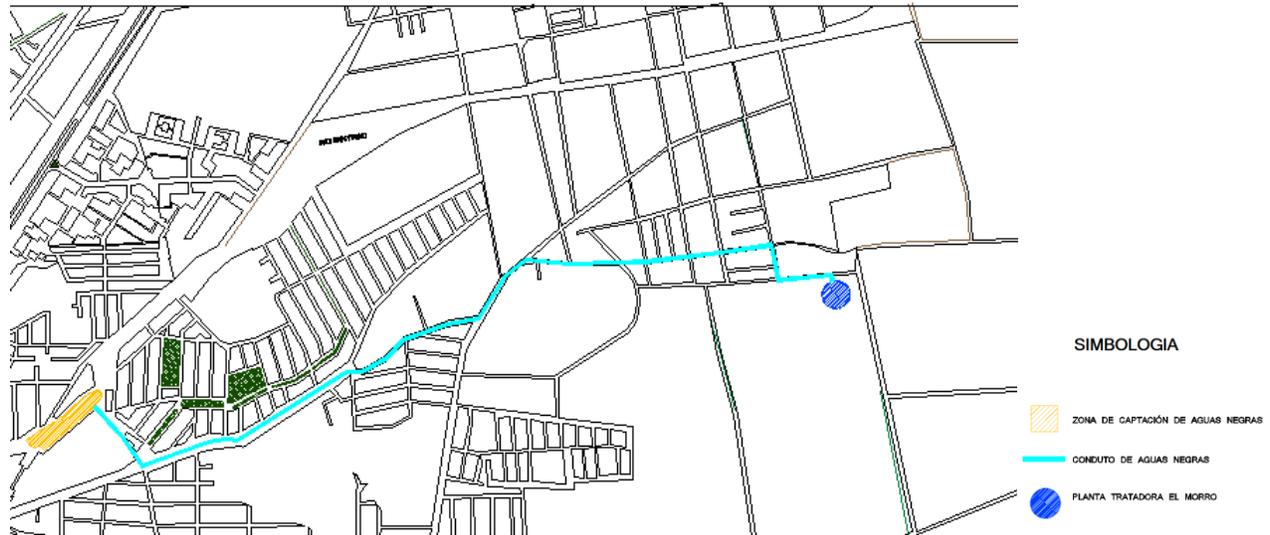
Proyecto Río de Santiago. Plan Maestro y Propuesta
